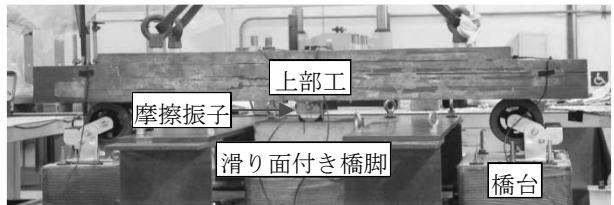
1本柱供試体設置状況（左右方向：橋軸）
